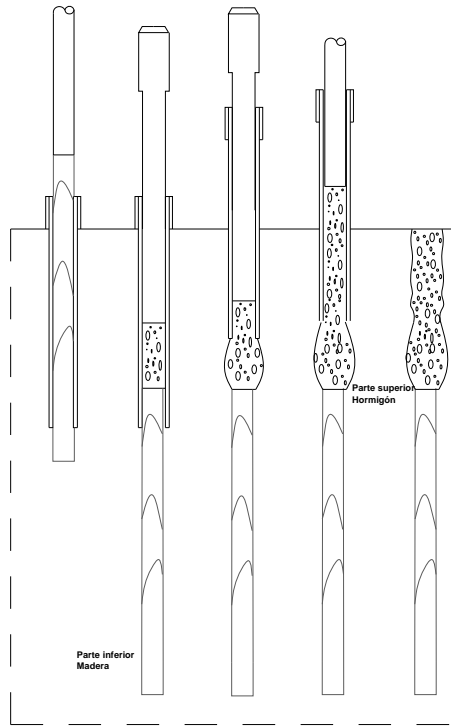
Proceso constructivo pilote mixto madera hormigón.⁹
